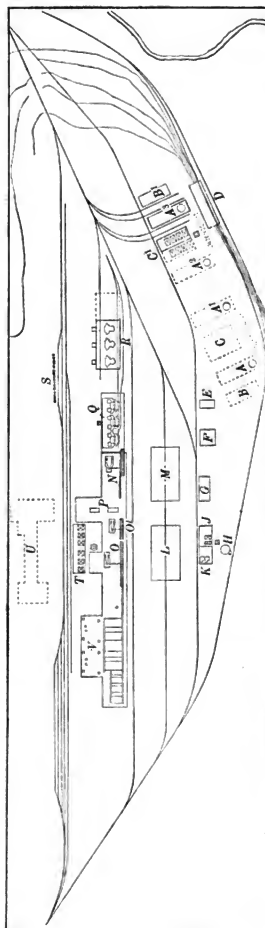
Lageplan der Stahlwerke in Monterey.
